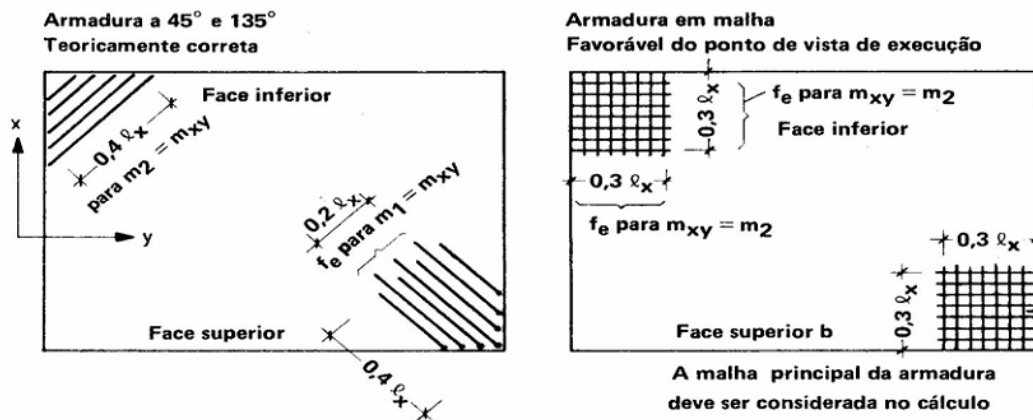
Armaduras de canto nas lajes – FUZIHARA (2008)
